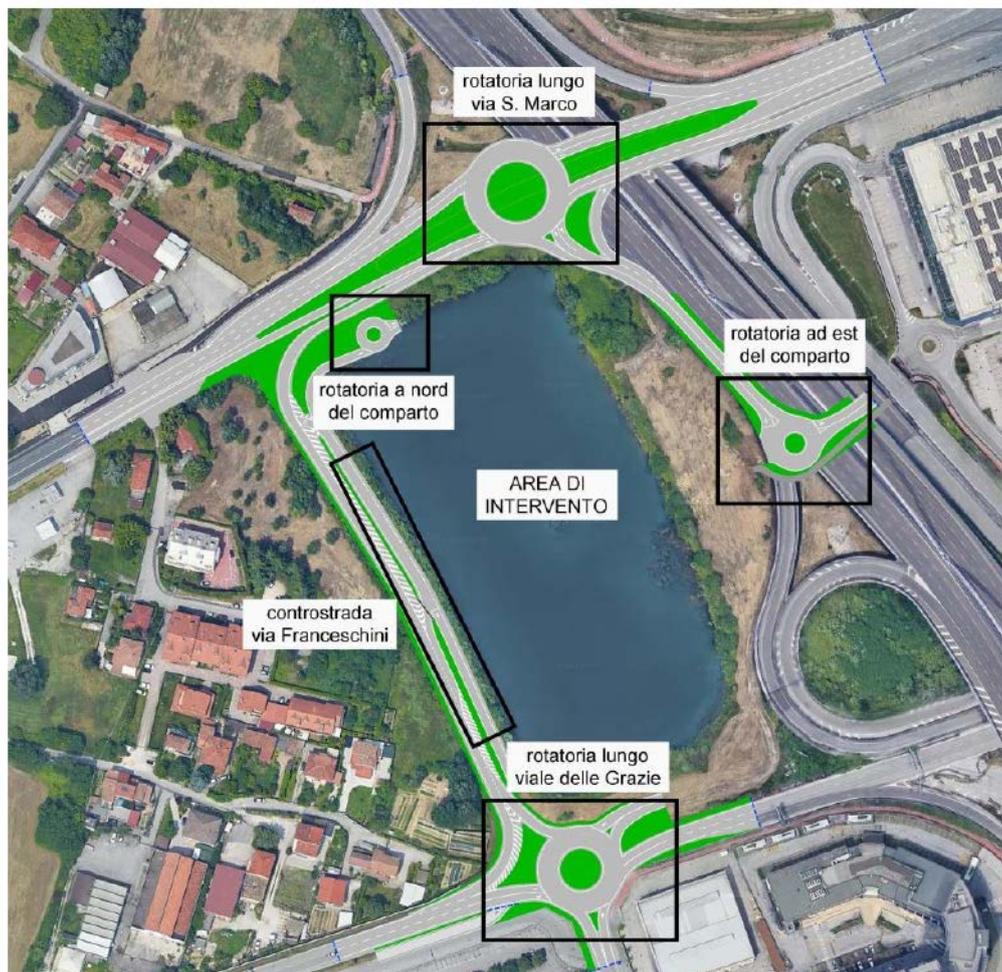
Estratto ortofoto con individuazione intersezioni oggetto di riconfigurazione
